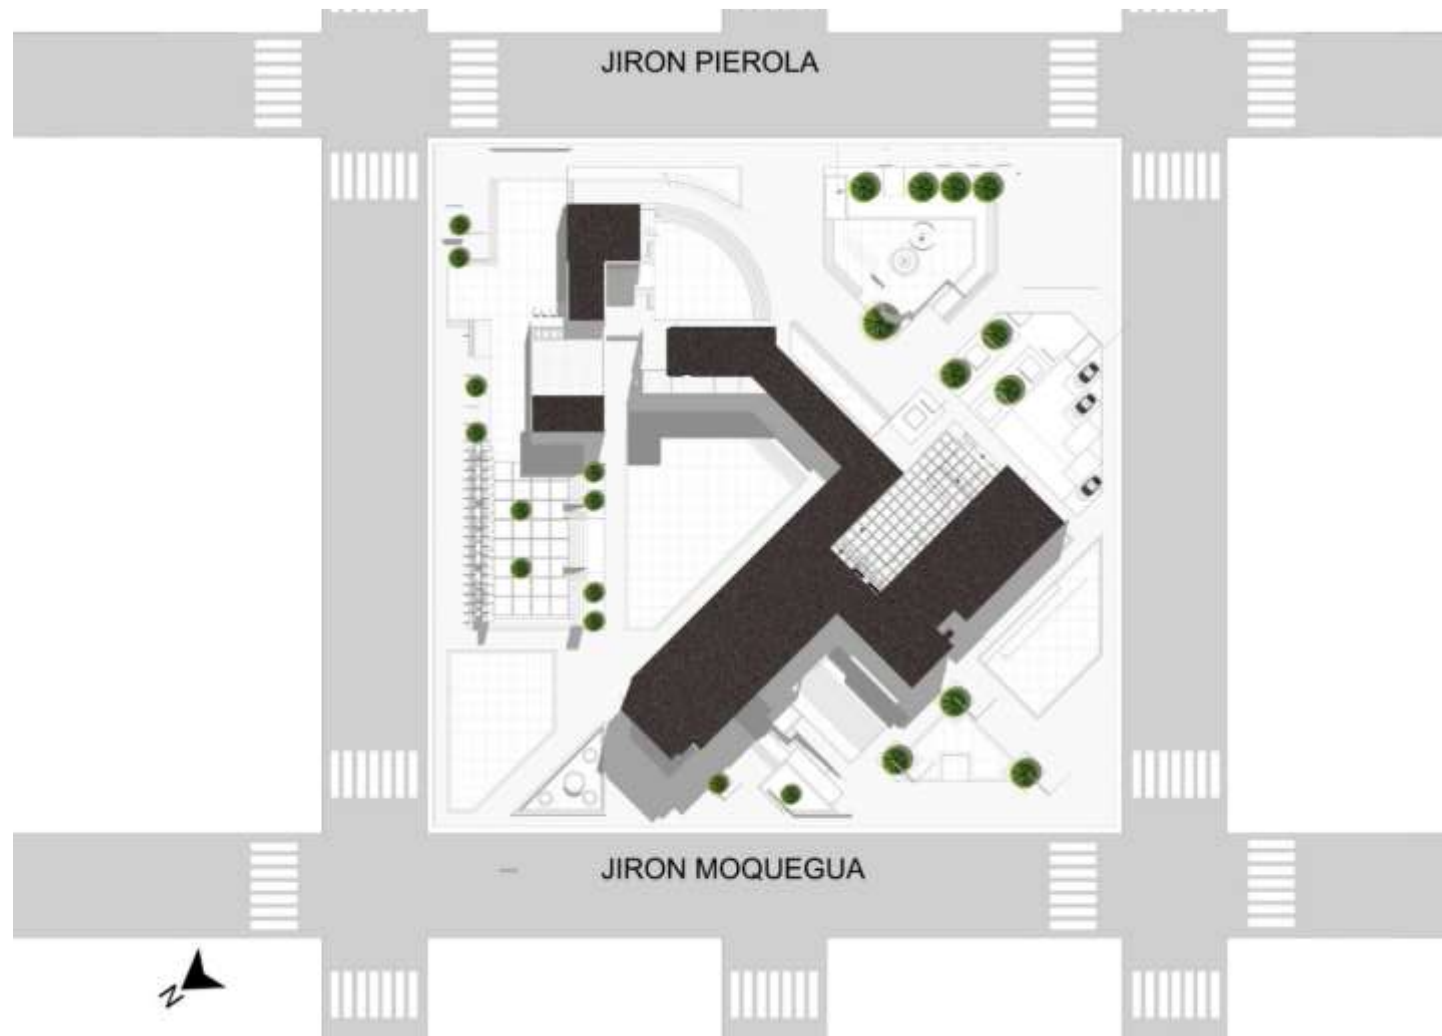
Plano en planta del proyecto centro cívico en la urbanización los Ángeles de Juliaca, sector B
